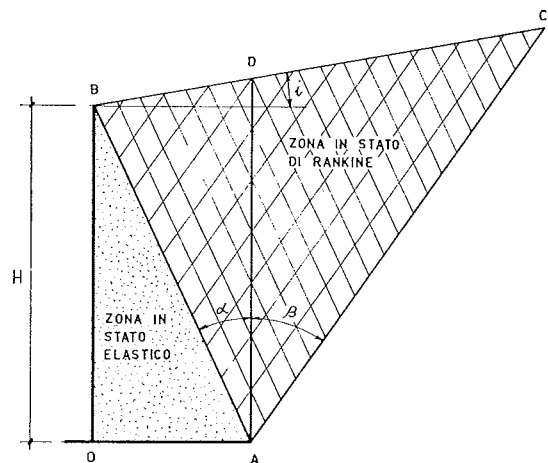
Zona di Rankine e zona in stato elastico alle spalle di un muro a mensola.
